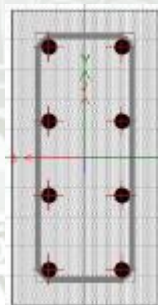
Sección Transversal Columna 25x50 cm (Deriva máx = 0.007)
